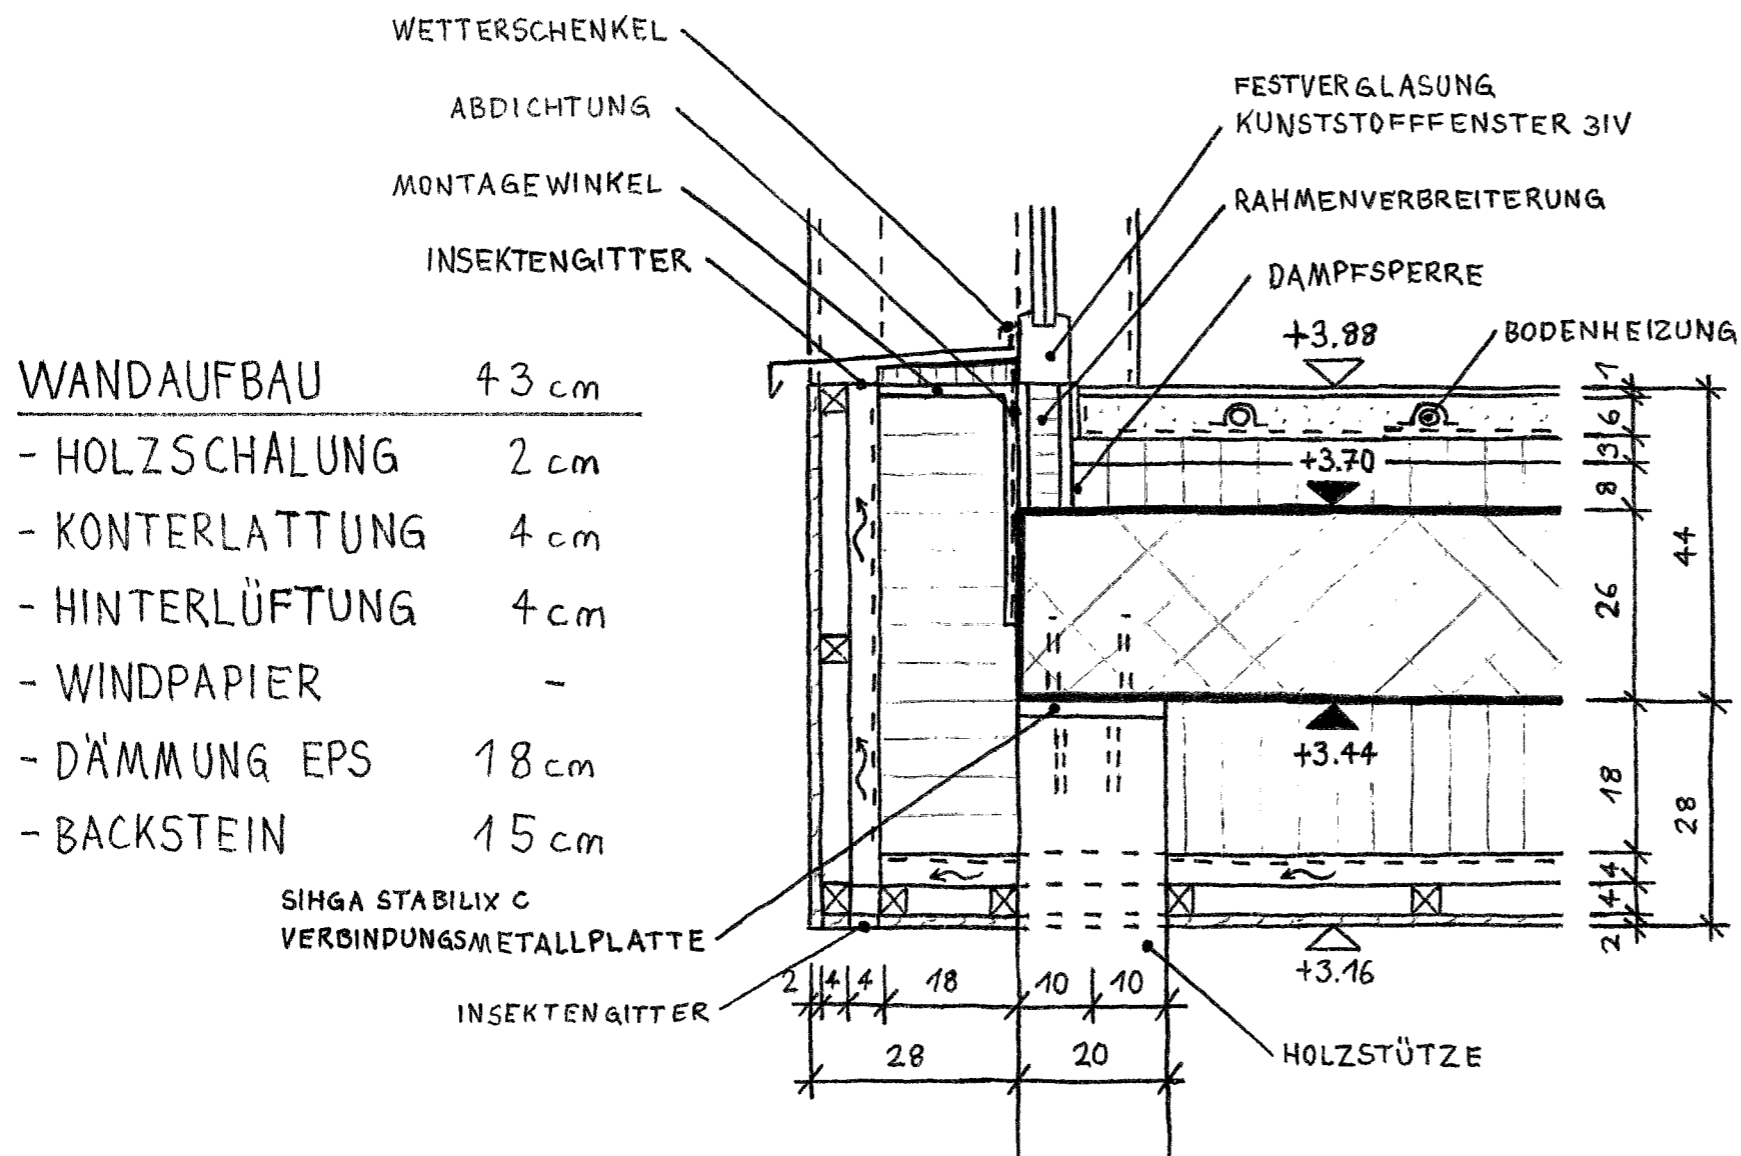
GRUNDRISSDETAIL OBERGESCHOSS
